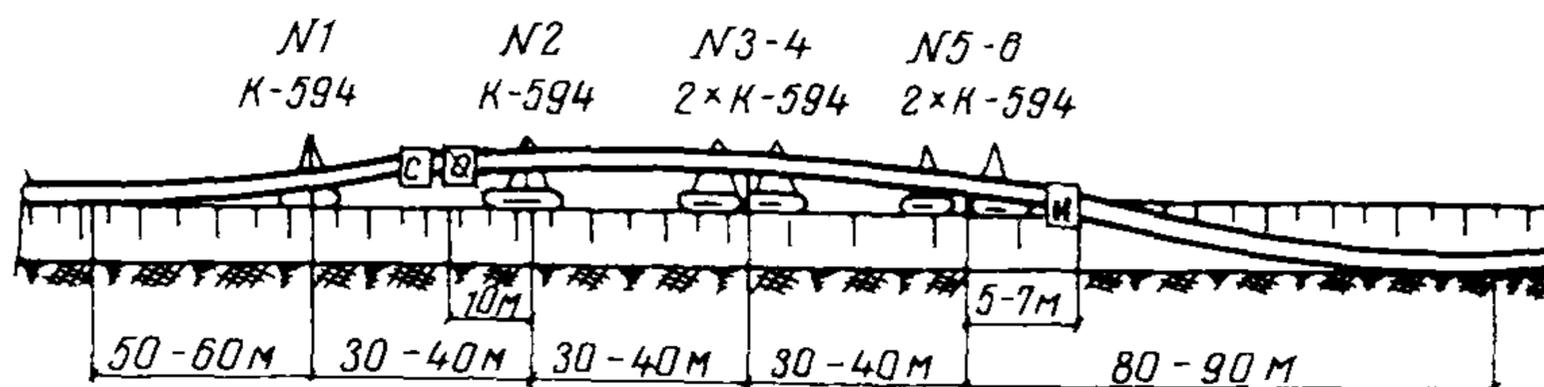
Размещение механизмов в колонне при укладке трубопровода ϕ 1420 мм в условиях устойчивых грунтов
